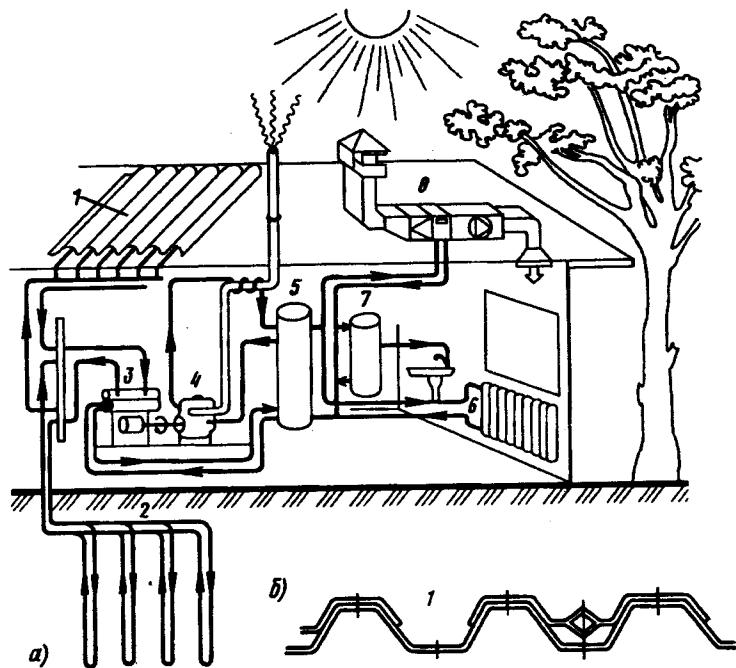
Тепловая установка здания гимназии в Швеции г. Кунгсбака
